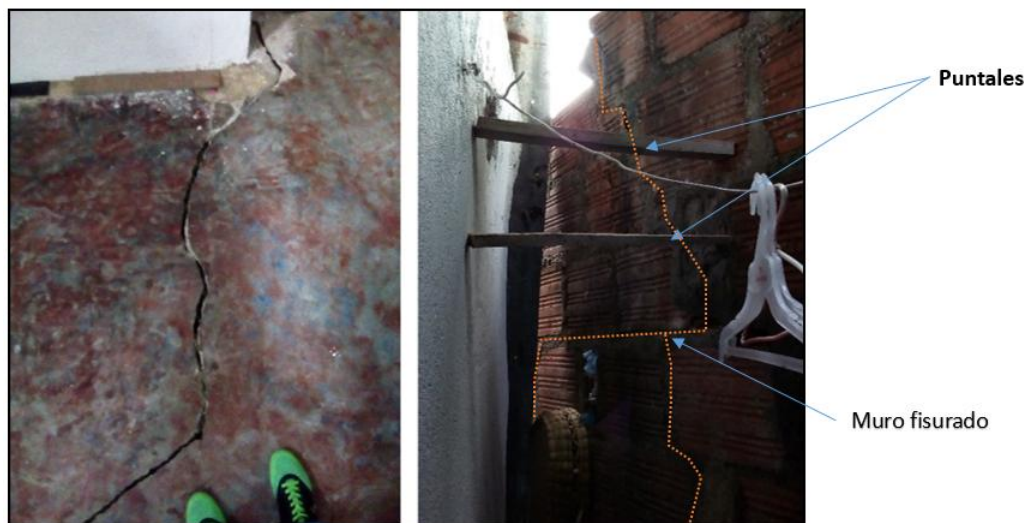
Evidencia de fisuras y grietas dentro de la vivienda, ubicada en la corona del talud #1.
